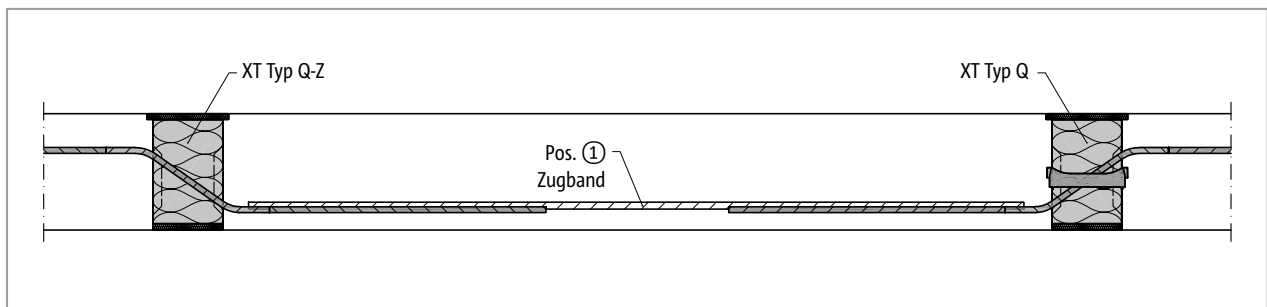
Schöck Isokorb® XT Typ Q-Z-V5 bis Q-Z-V11, Q-V5 bis Q-V11: Schnitt A-A; einachsig gespannte Stahlbetonplatte
